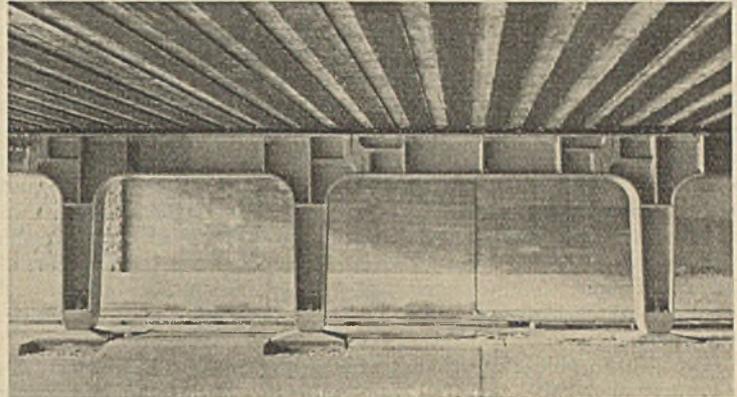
Sandstraßenunterführung. Pendelrahmen.
